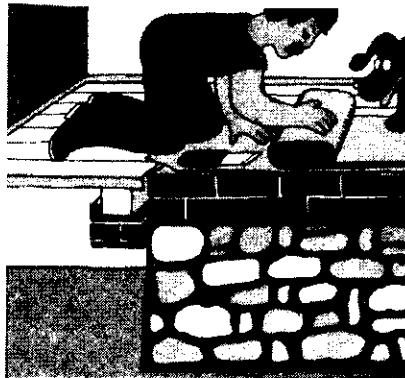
Фундамент под печь и устройство изоляции из рубероида
